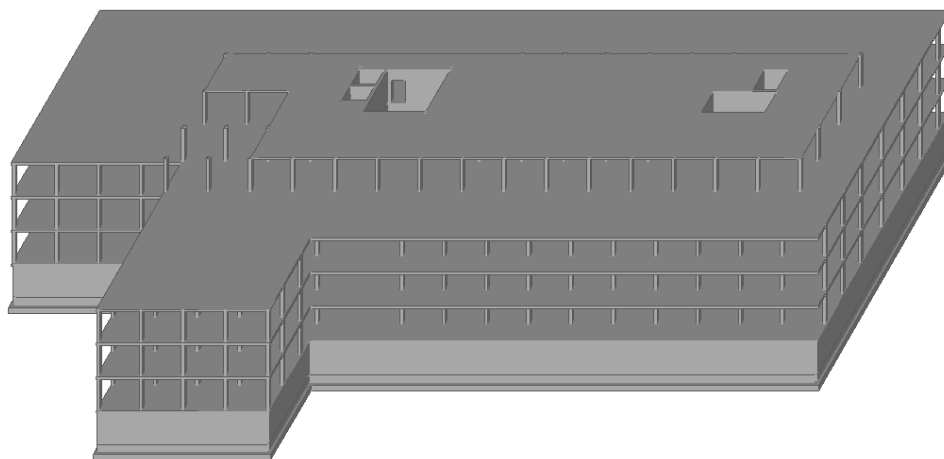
Сформована розрахункова схема будівлі у тривимірному зображенні
